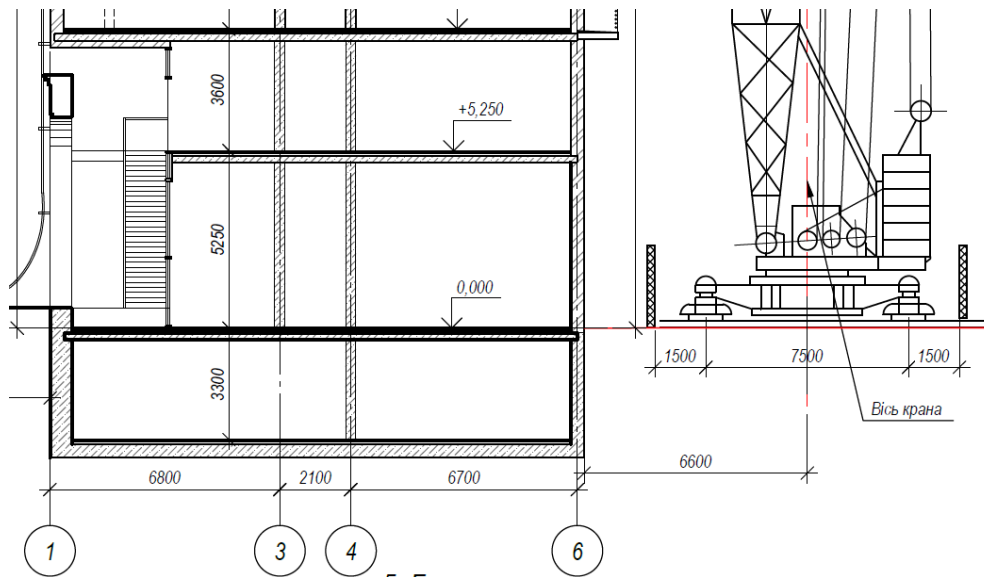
Схема прив'язки крану КБ-503А до будівлі
